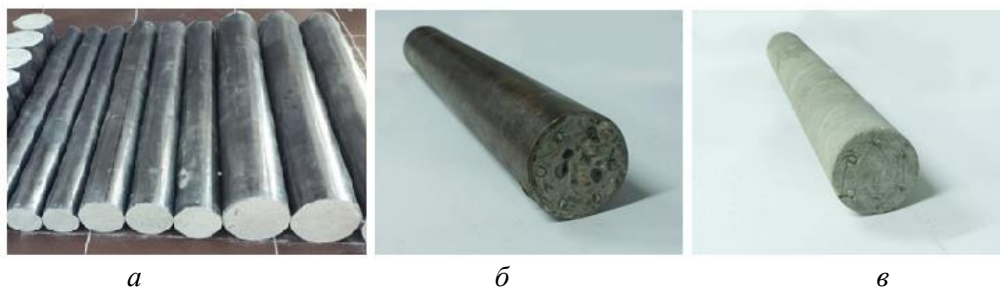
Модели колонн: *а* – неармированная трубобетонная, *б* – армированная трубобетонная, *в* – железобетонная
